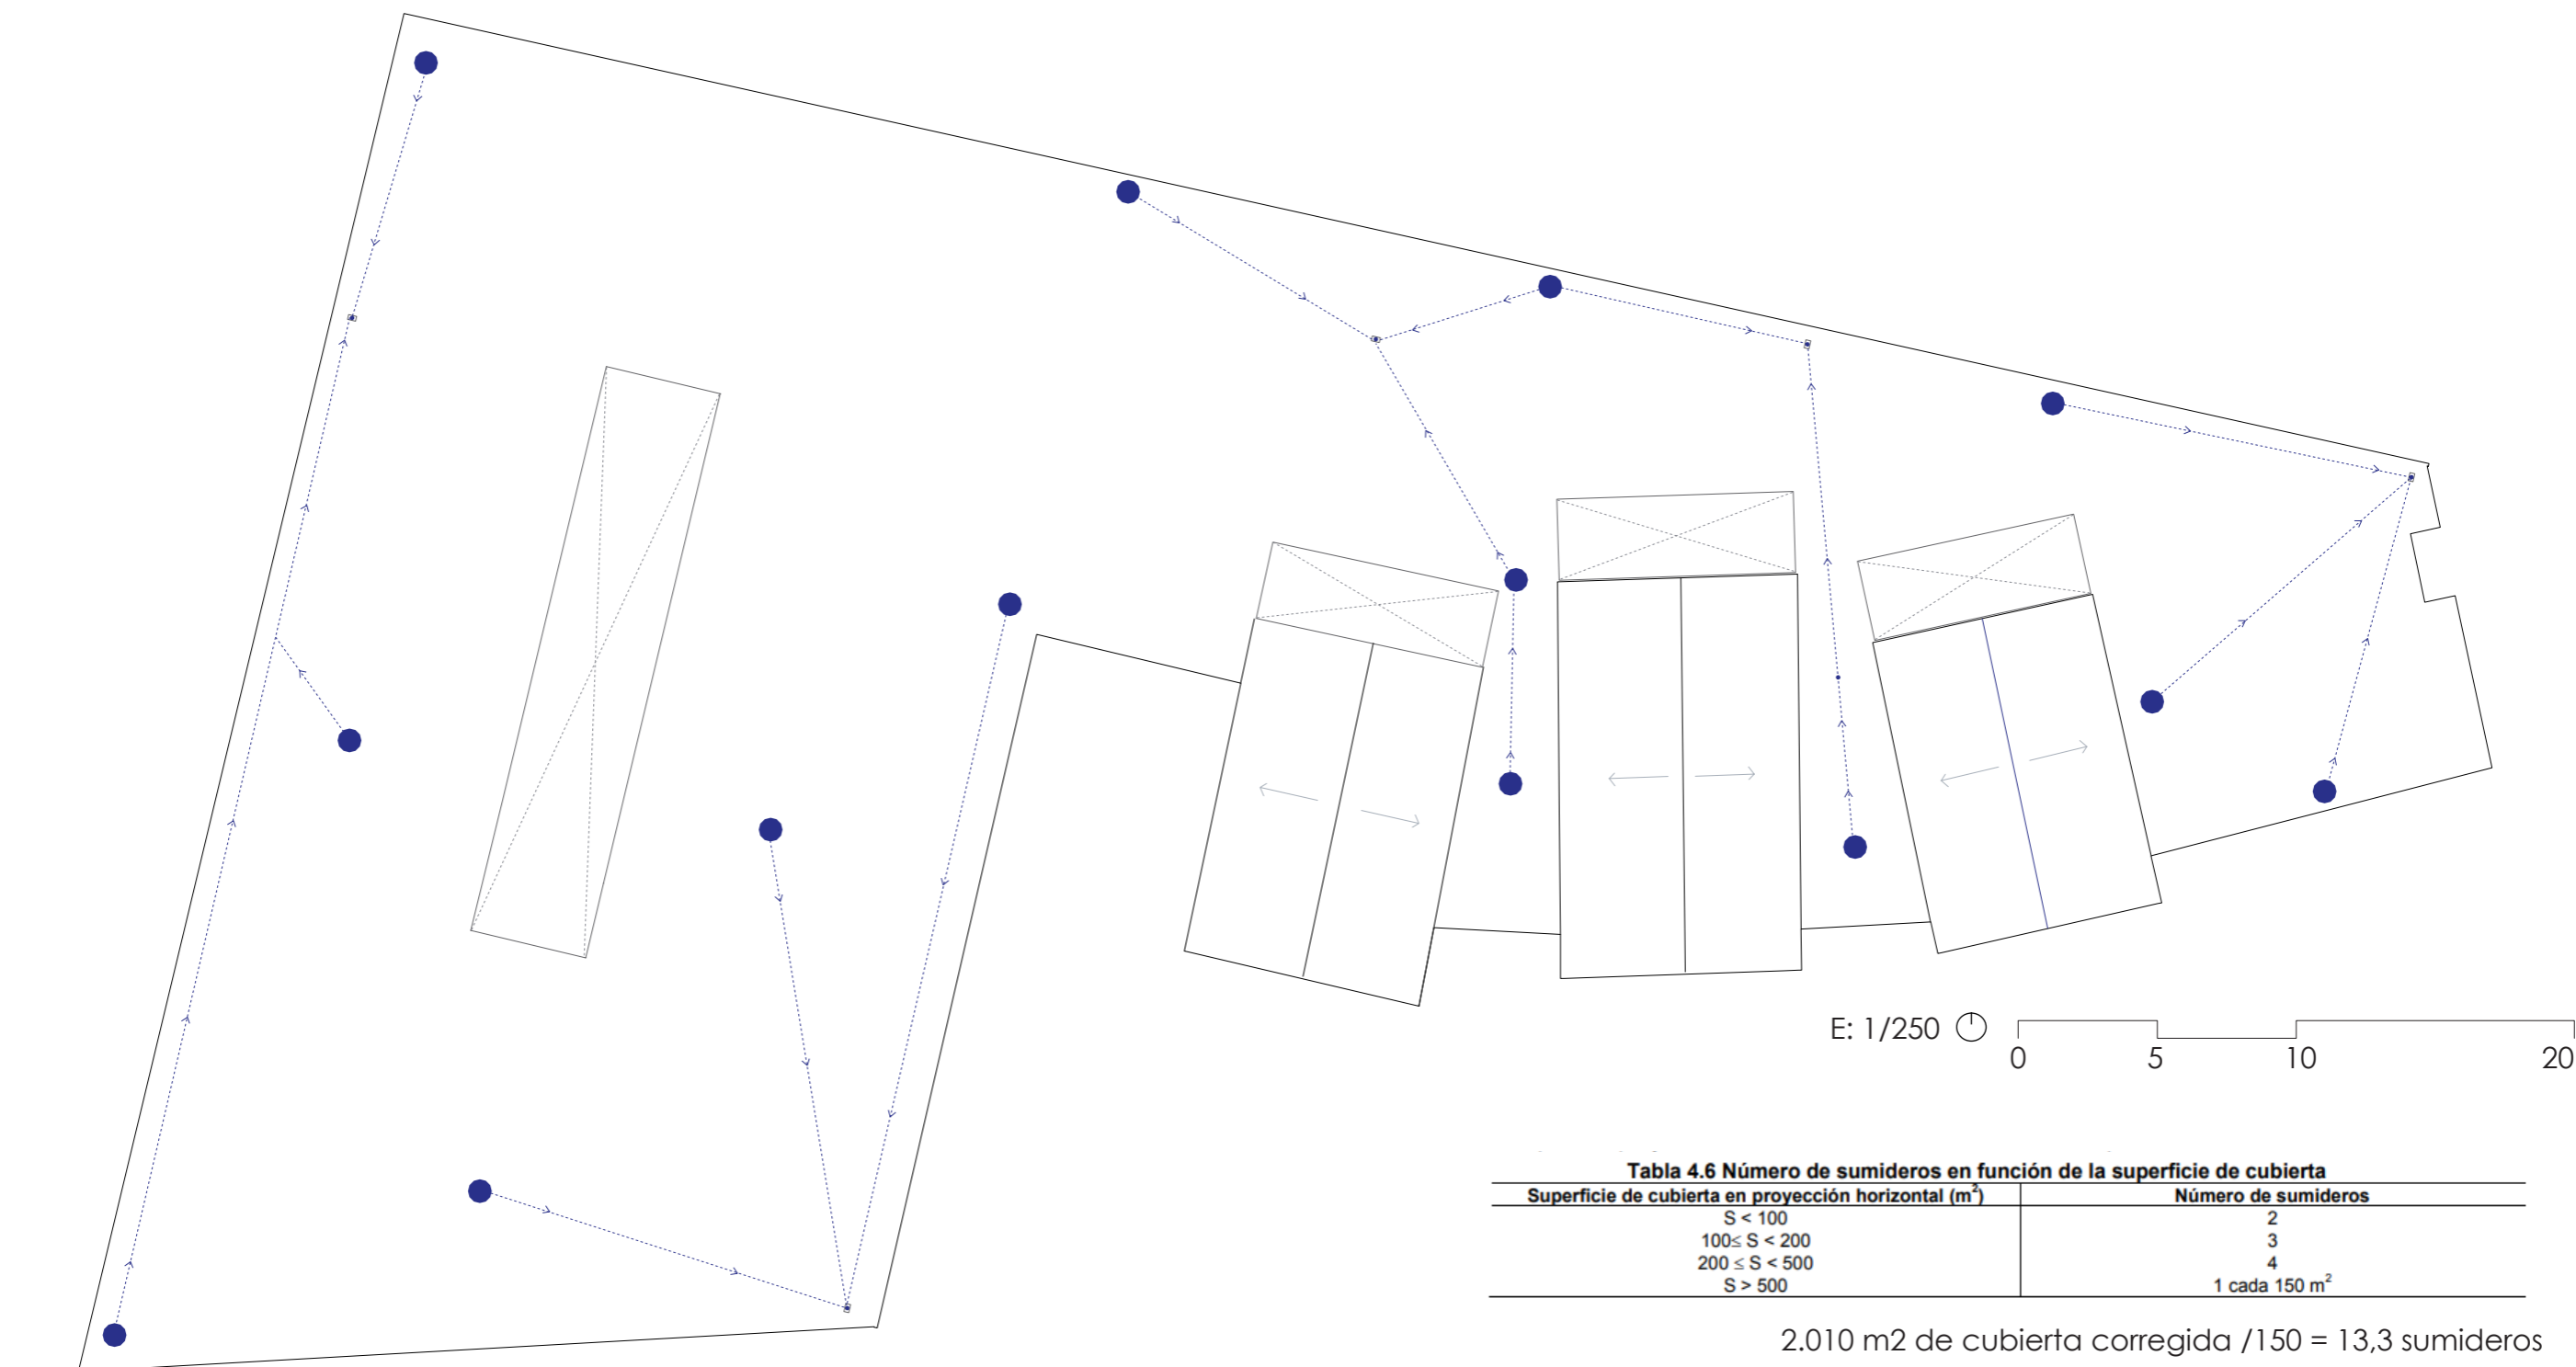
Recorridos aguas en cubierta hacia las bajantes pluviales
